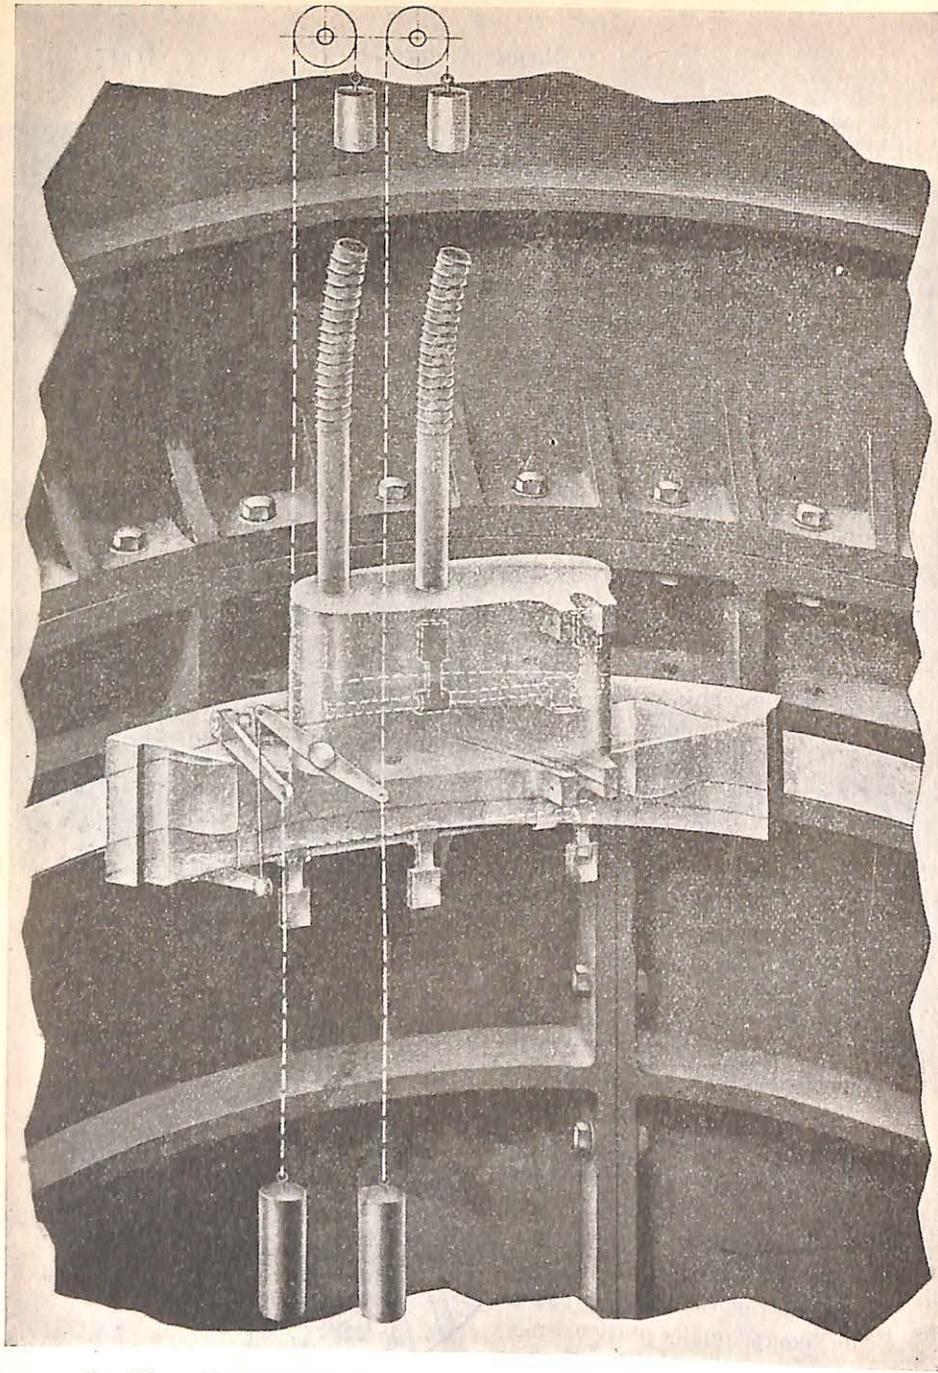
Vue d'ensemble du masque montrant le fonctionnement des touches destinées à obstruer les trous de boulons.
